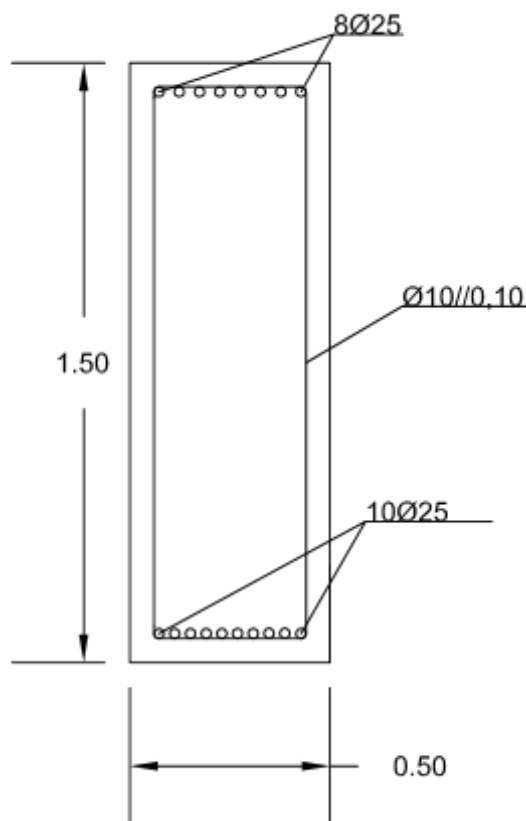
Armadura da viga com seção 50x150 m<sup>2</sup>
